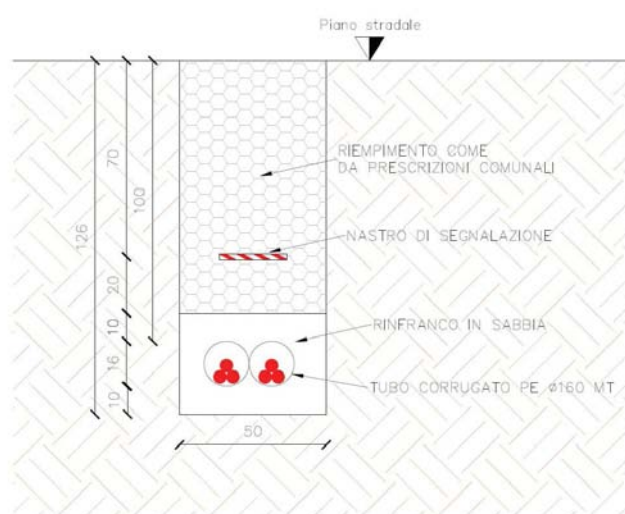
Sezione cavidotto MT su sede stradale Via Puglia
